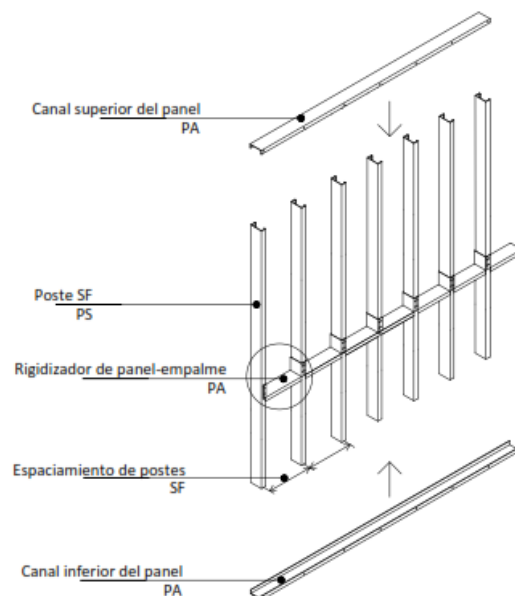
, Planta panel SF. (Fuente: propia del autor)
